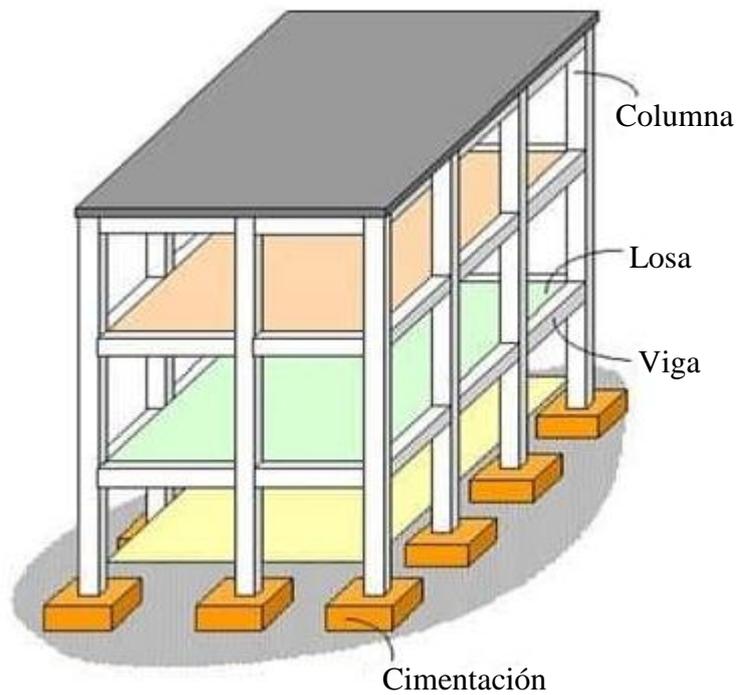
Elementos estructurales en un sistema de pórticos (Adaptado de: [13])
